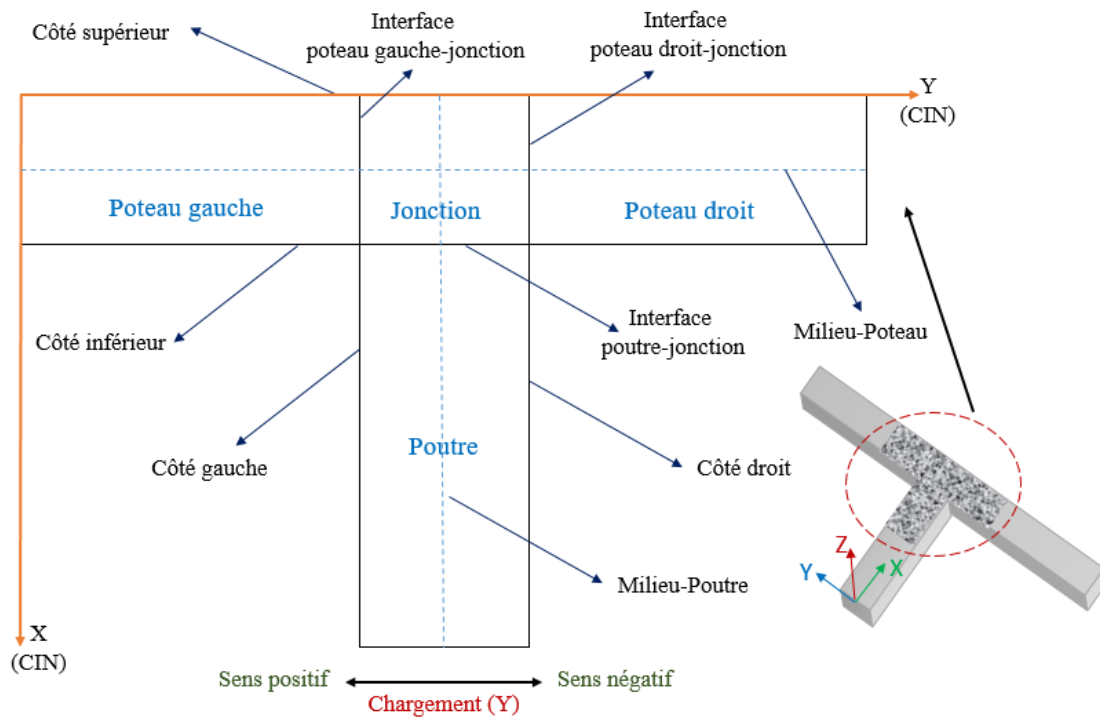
Assemblage poutre-poteau : Notations et directions du chargement
